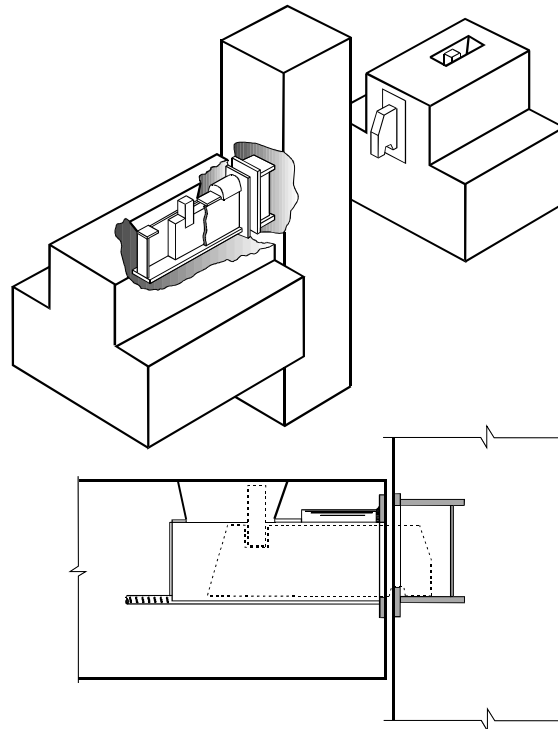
ligação em face viga-pilar (FIB, 2003)
